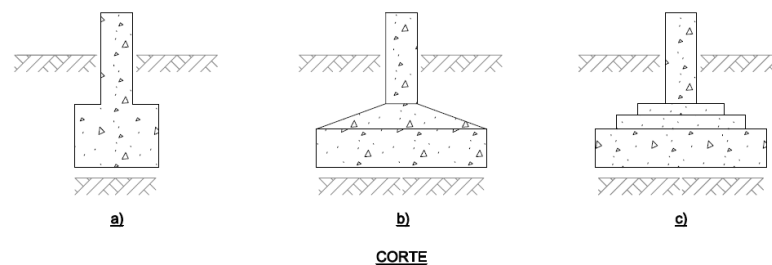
Tipos de cimentaciones de zapatas aisladas. a) Masa de concreto de espesor uniforme, b) concreto reforzado con forma de pirámide, c) Concreto escalonado reforzado (Peck, 1988)
